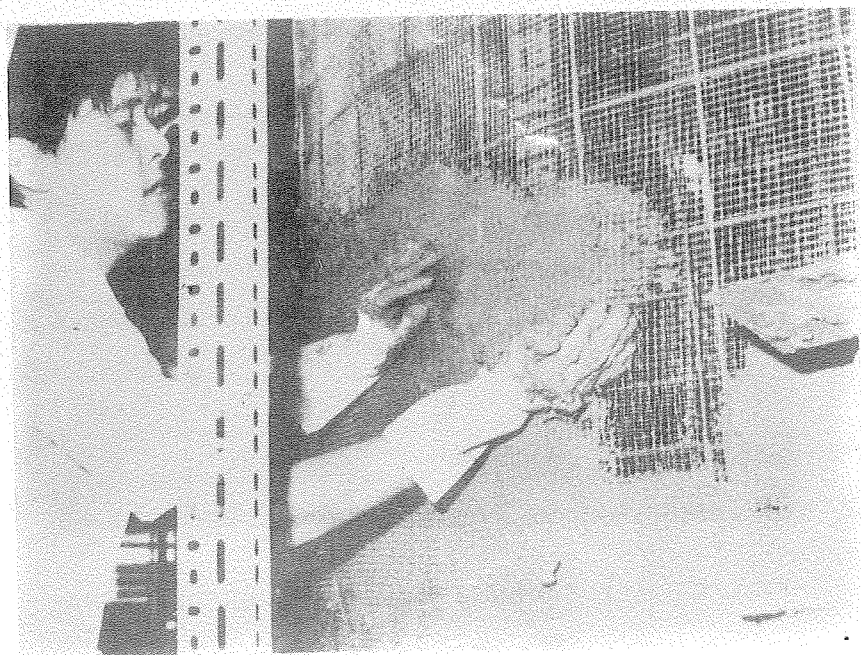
II - MOLDAGEM POR PRESSÃO, EFETUADA MANUALMENTE.¹⁷⁵
